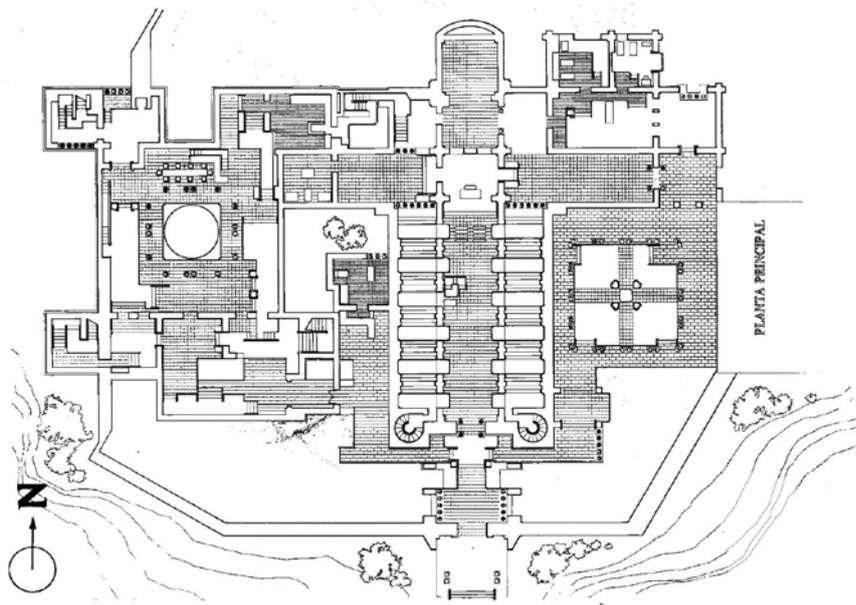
Planta del Convento en el videojuego La abadía del crimen.
